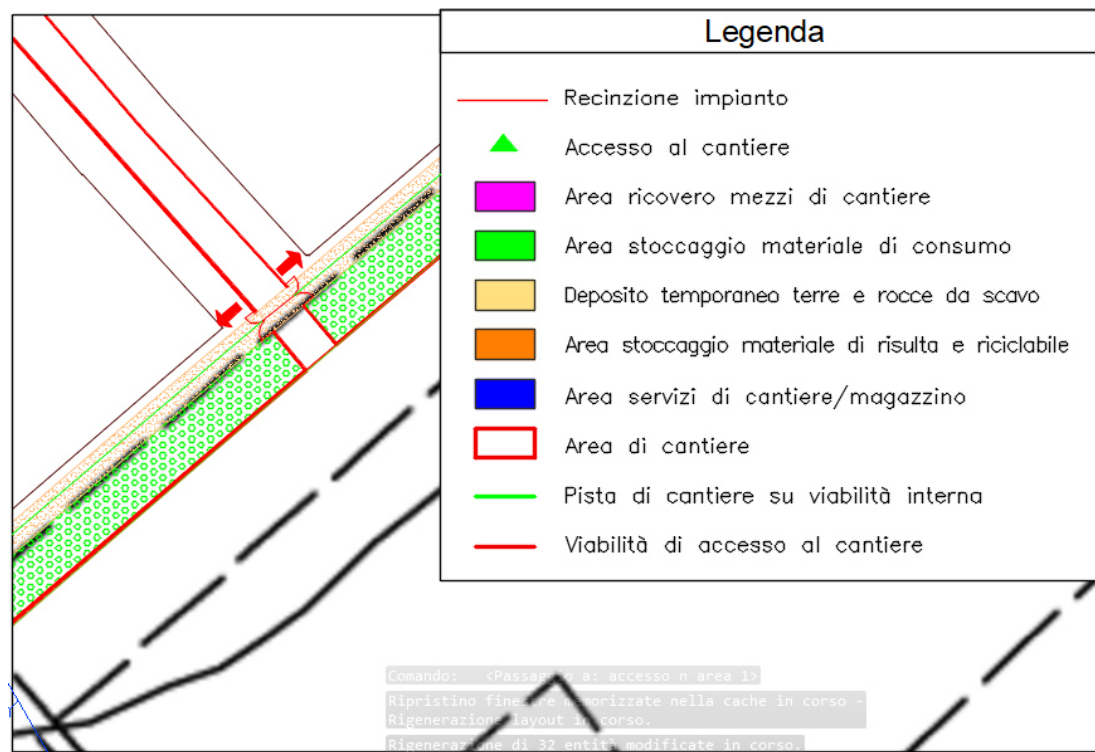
| Particolare accessi 6 e 7 area di cantiere 1
